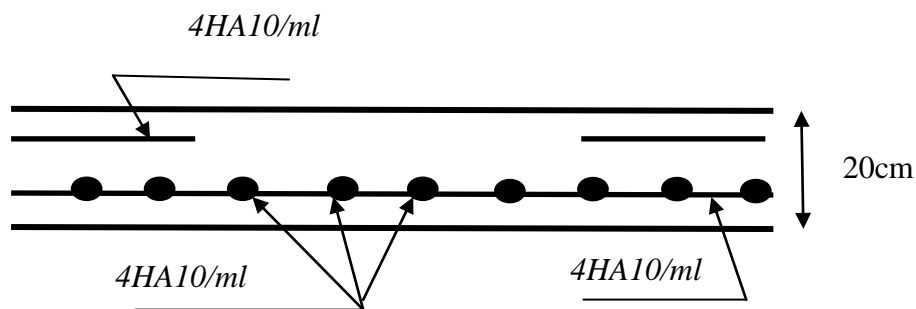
schéma de ferrailage de la dalle d'ascenseur
